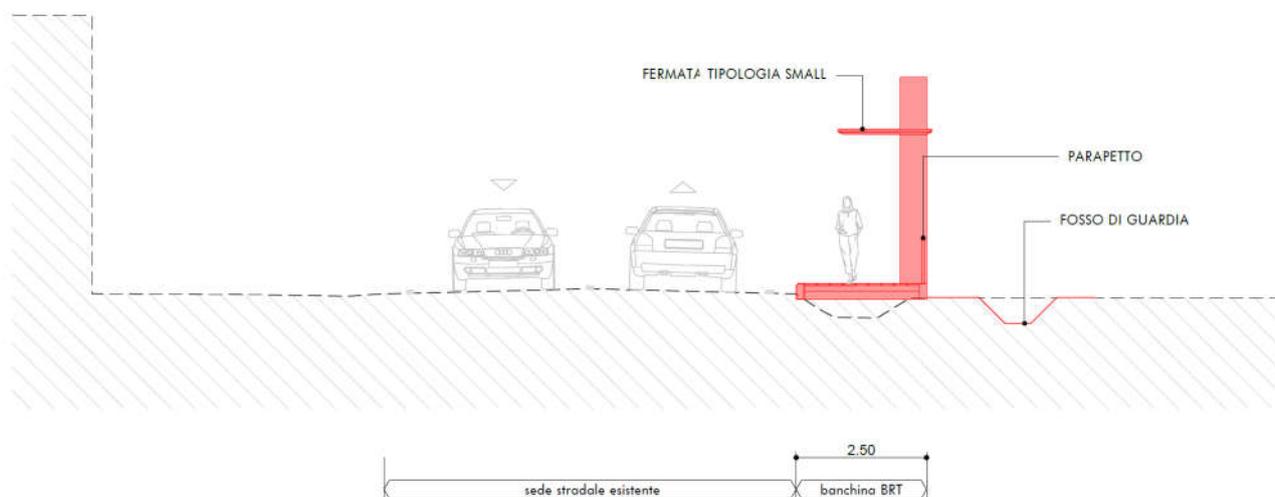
Fermata Armarolo. Sezione Tipologica 1.
